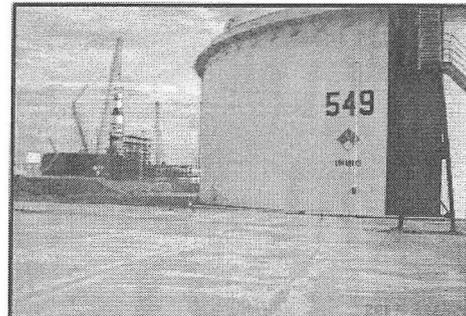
FOTO XIV: Tanque NL 549, muro y piso impermeabilizado.
